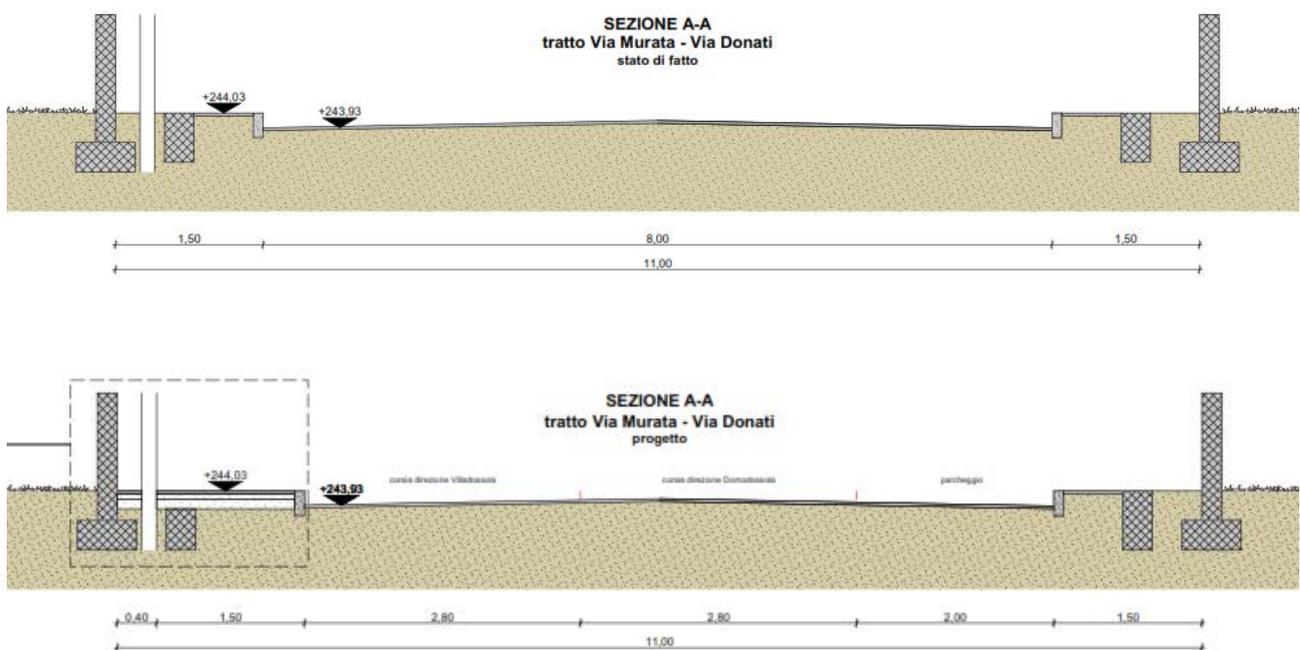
Sezioni Stato di Fatto e Progetto - Tratto Via Murata - Via Donati
